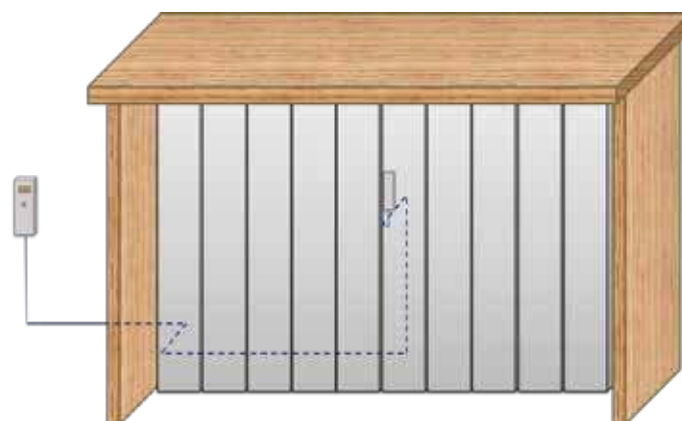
Esquema de instalación de un sensor remoto en un radiador con cubre radiador.
